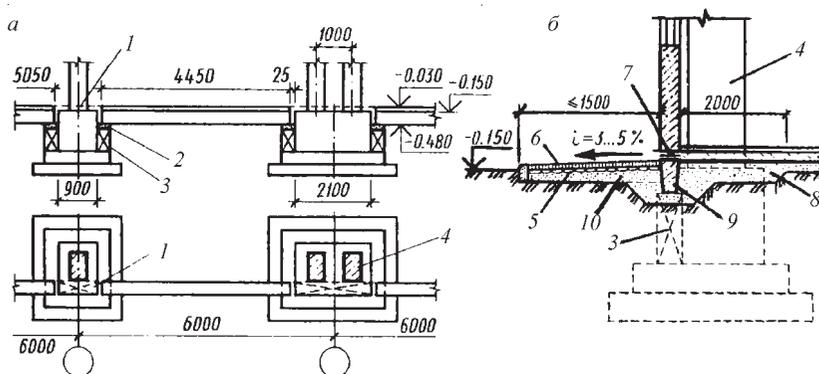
Опираие фундаментных балок на столбики или бетонные приливы:
